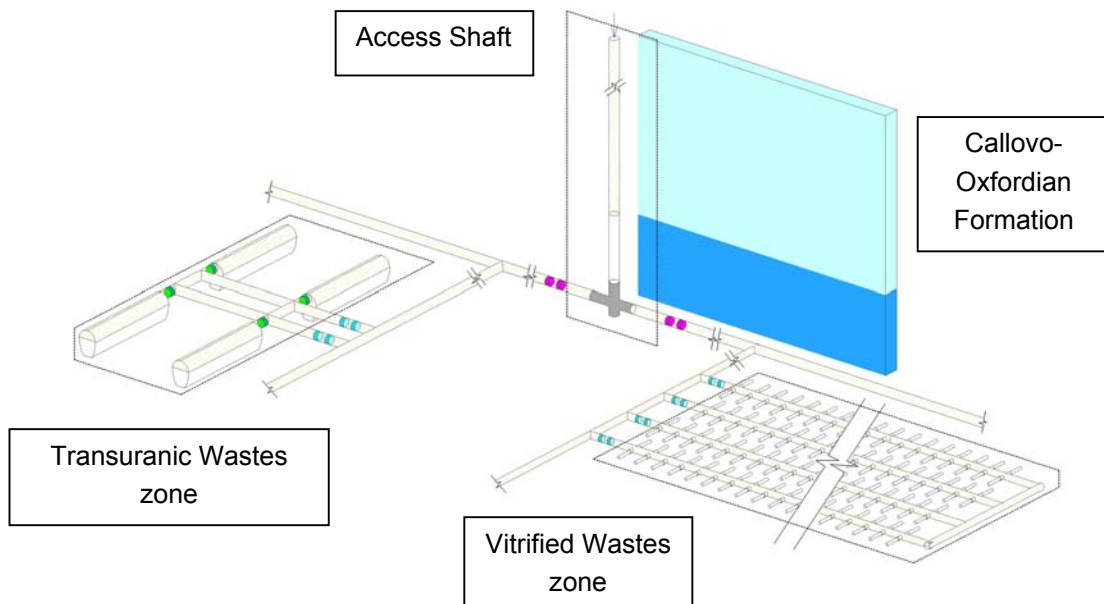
Schematisches Layout des Endlagers (Ausschnitt)
